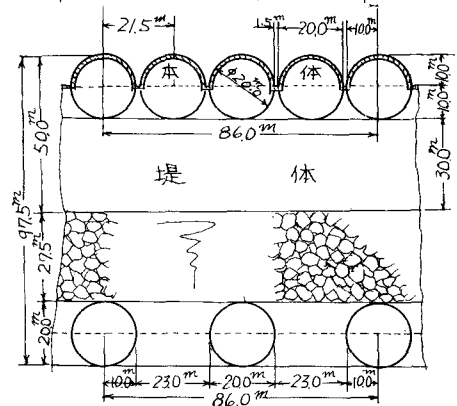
大阪湾防波堤断面図及平面図 (当初の案)
